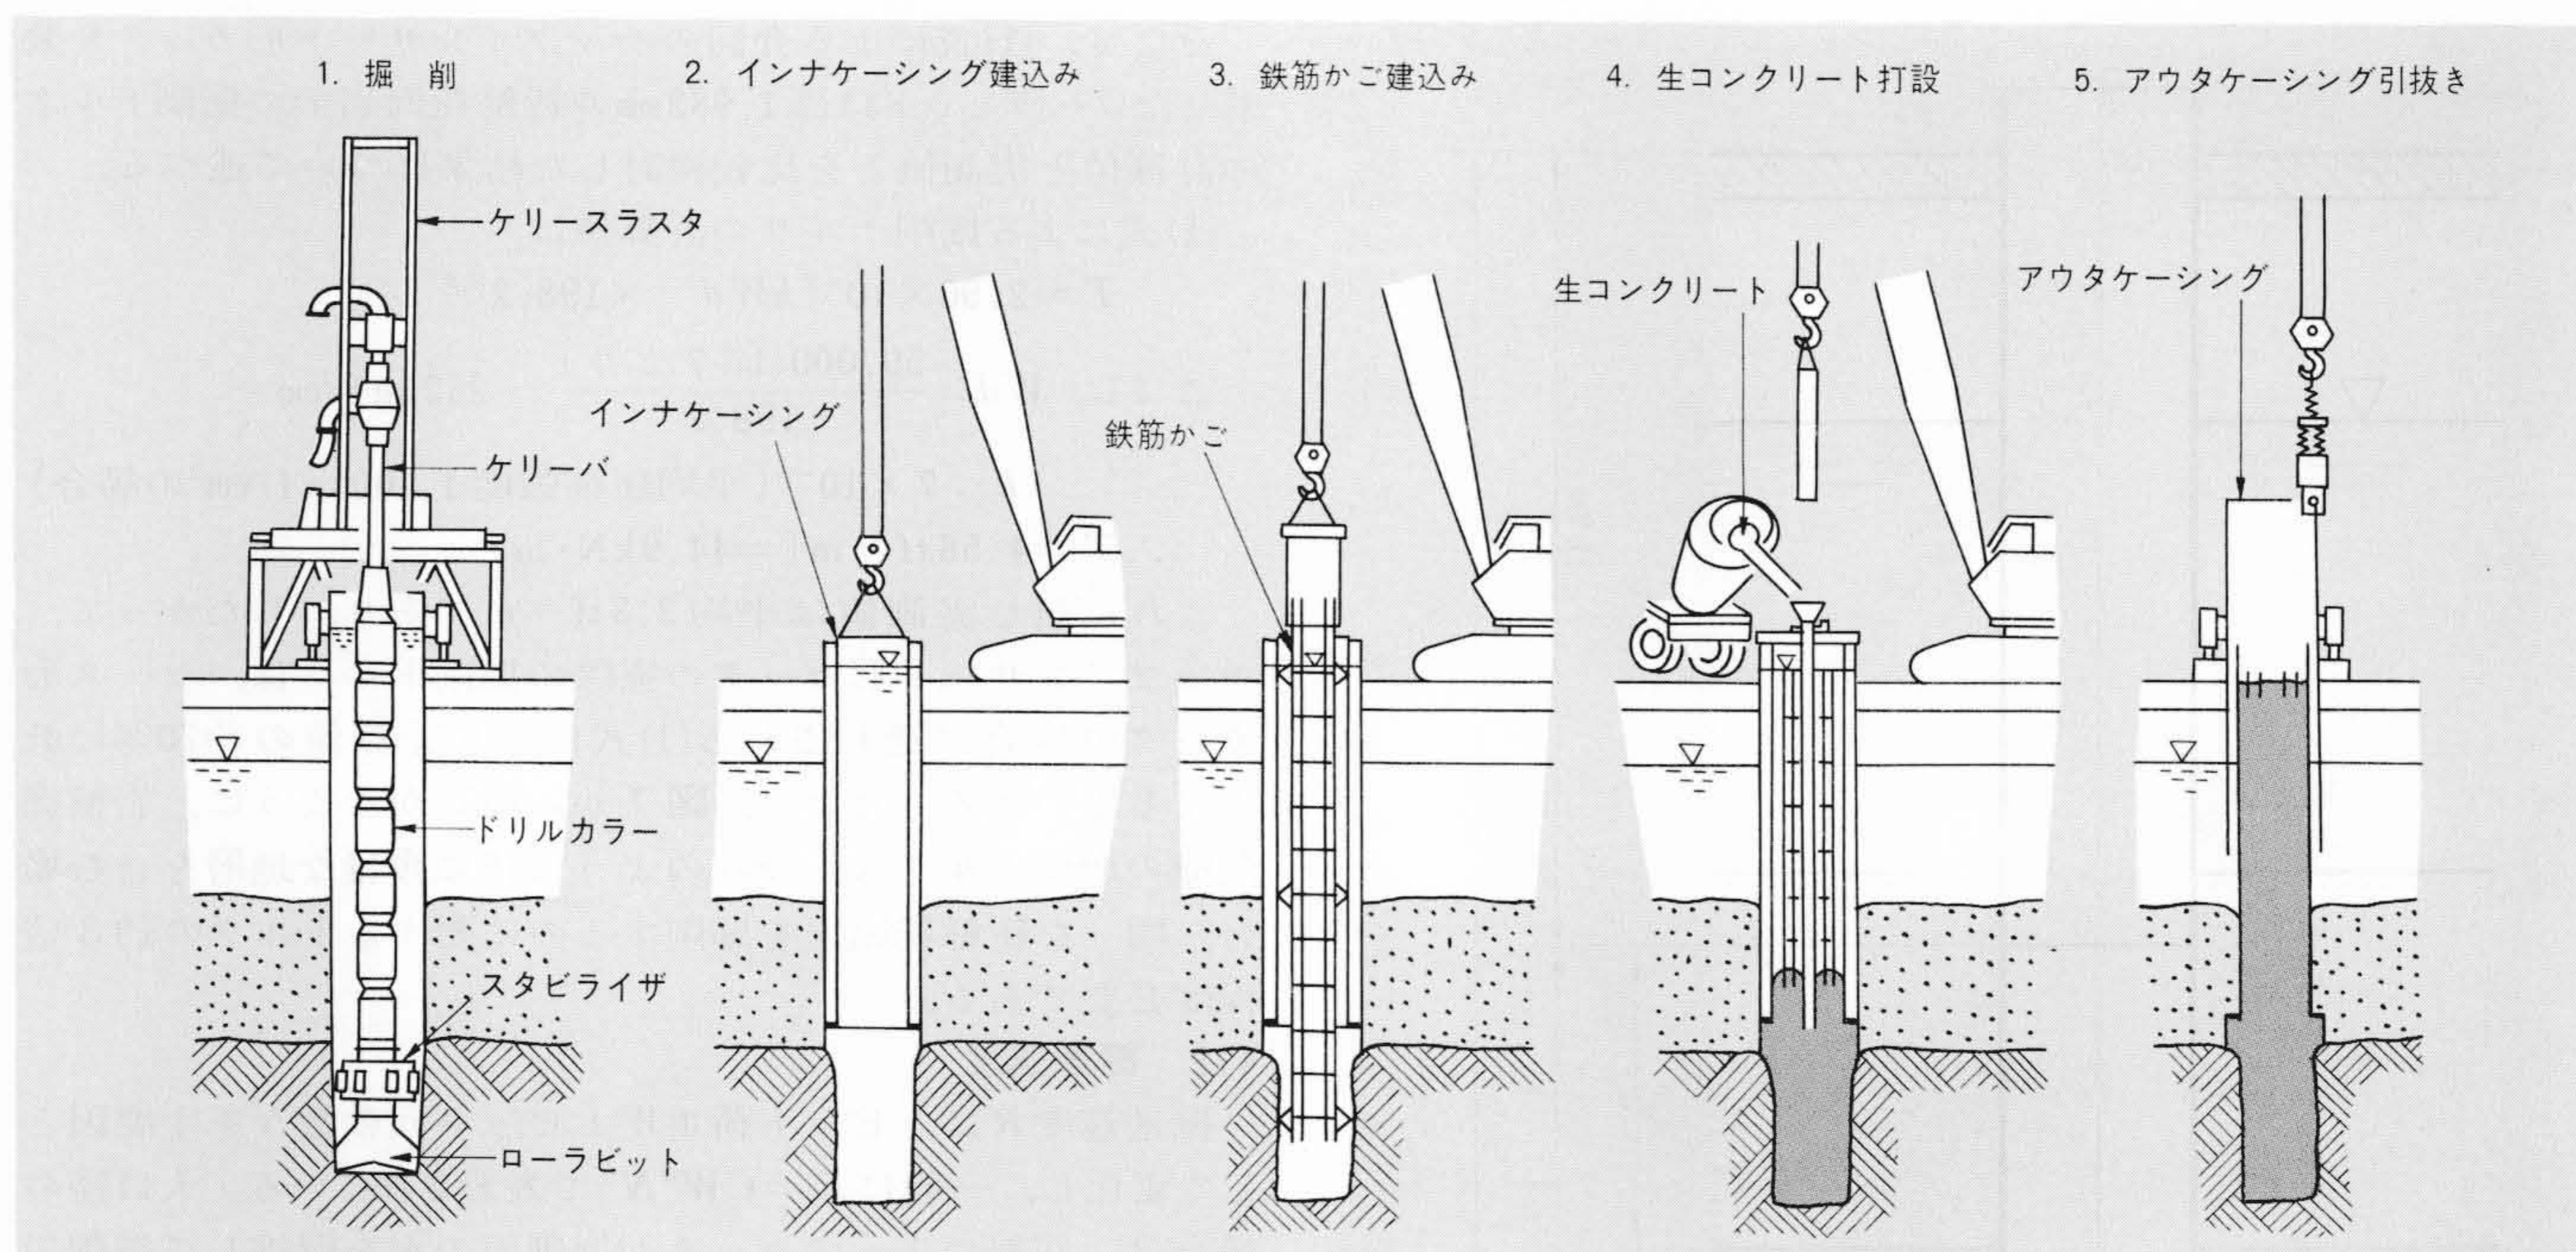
ホンコン海上ホテル杭基礎工事の施工法 インナケーシングを杭の途中まで建て込み、海中で生コンクリートを打設する施工法である。
